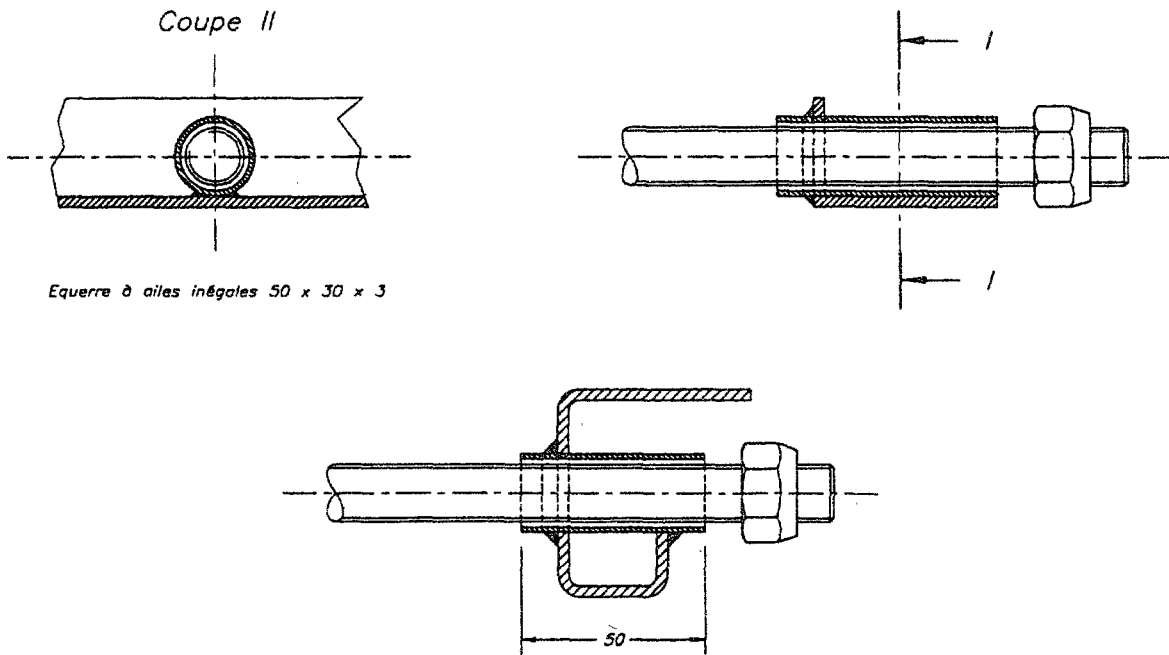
PASSAGE DU JOINT DE L'OUVRAGE POUR LES PANNEAUX
